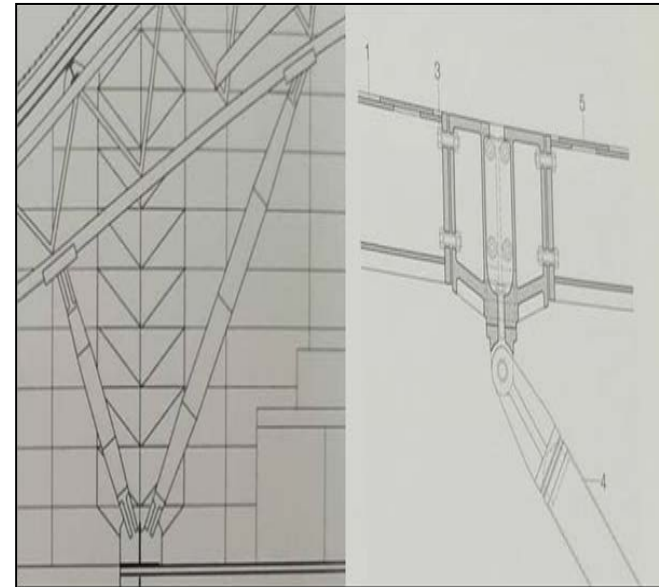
assemblage du poteau arborescent avec la poutre triangulée
